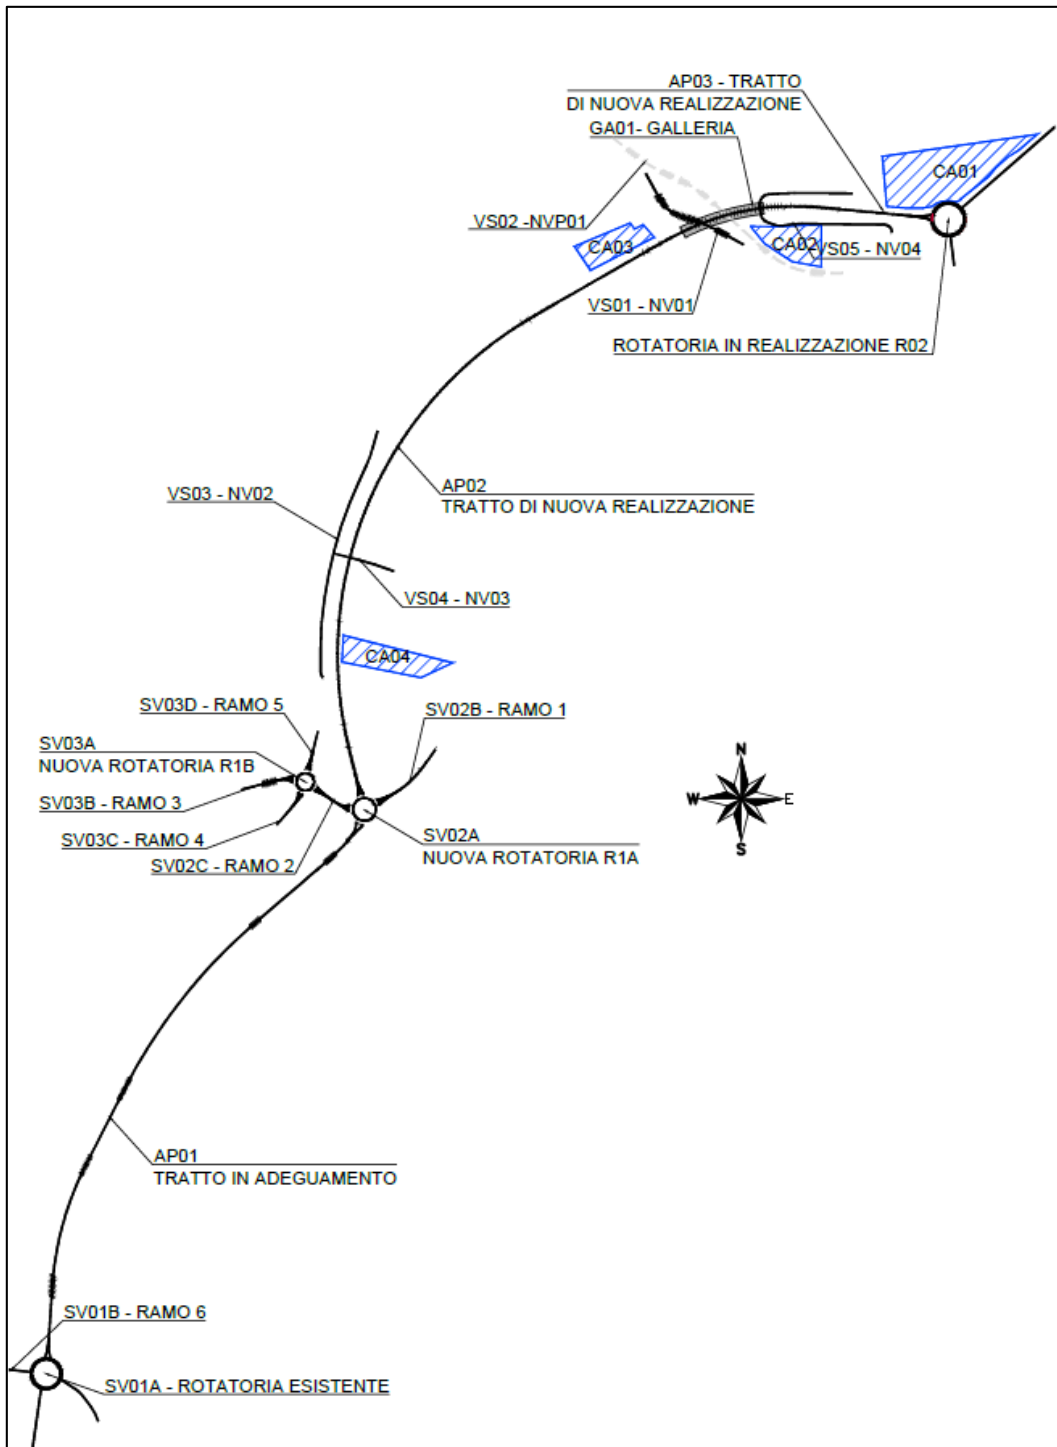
K-PLAN con ubicazione dei cantieri
